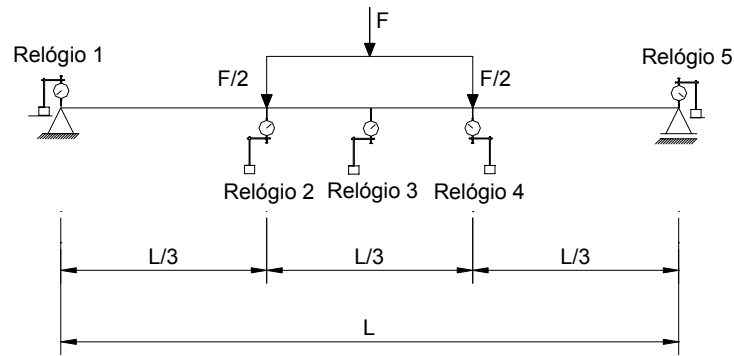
Esquema estático do ensaio das vigas de MLC.
